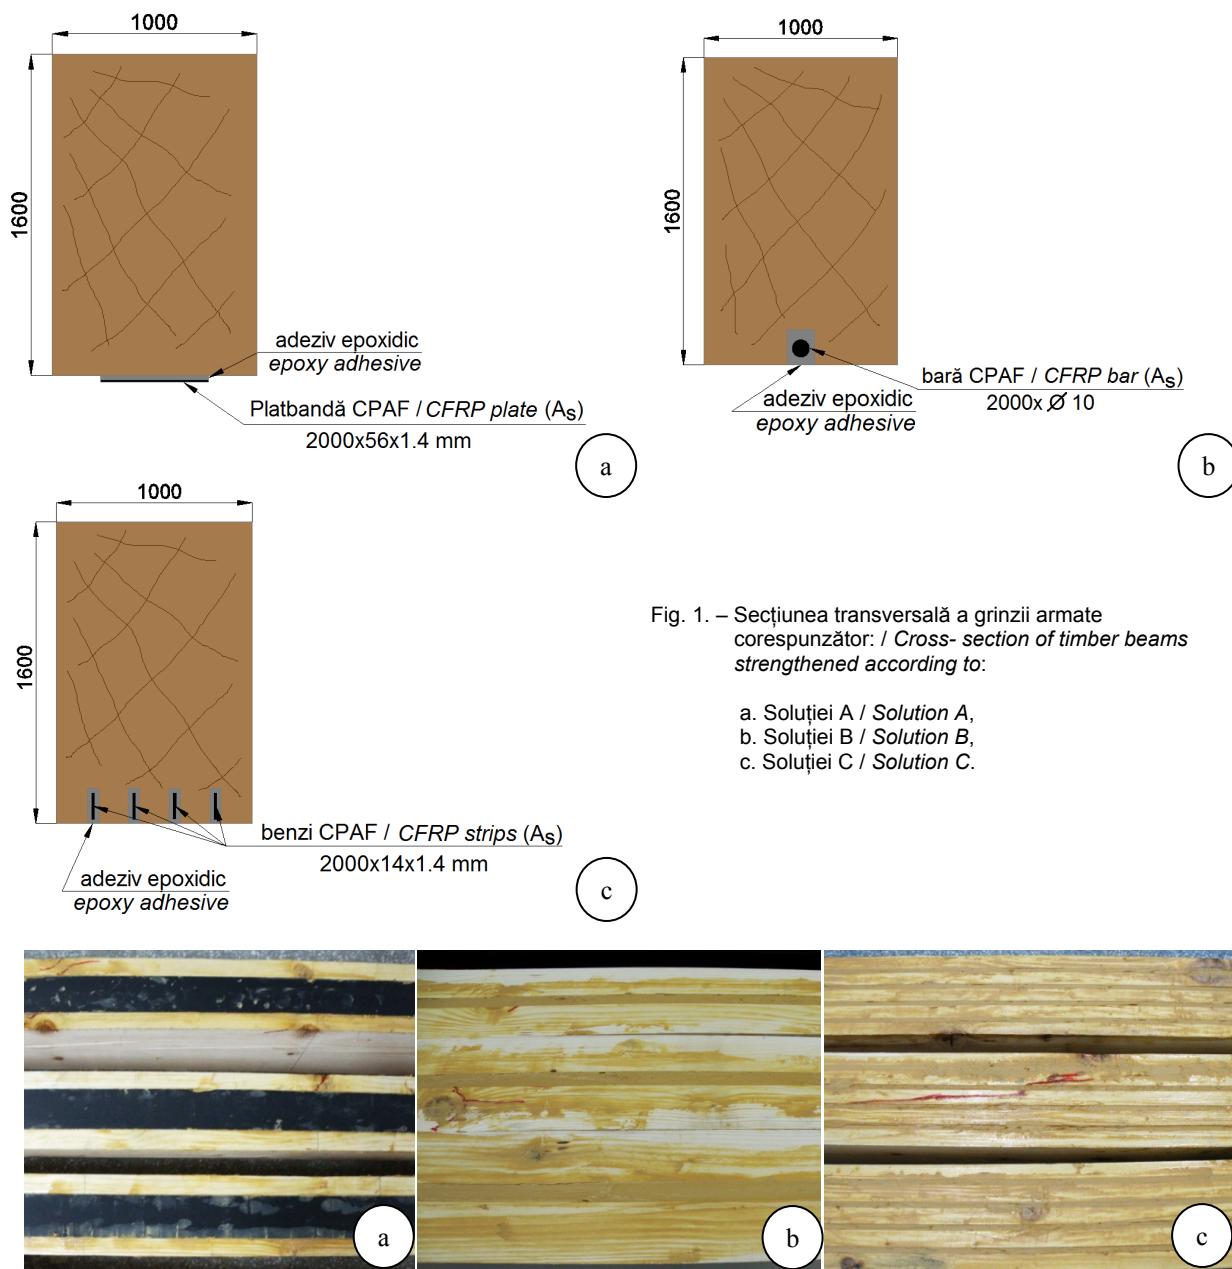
Secțiunea transversală a grinzi armate corespunzător: / Cross- section of timber beams strengthened according to:
